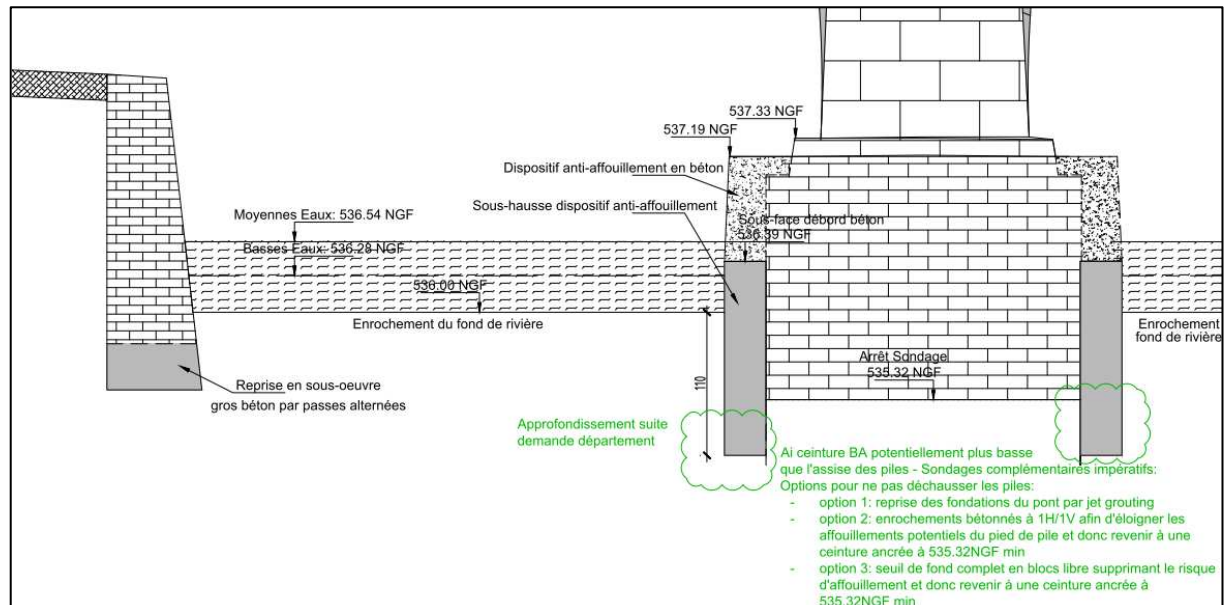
Coupe de principe des mesures de confortement des piles et soutènement
